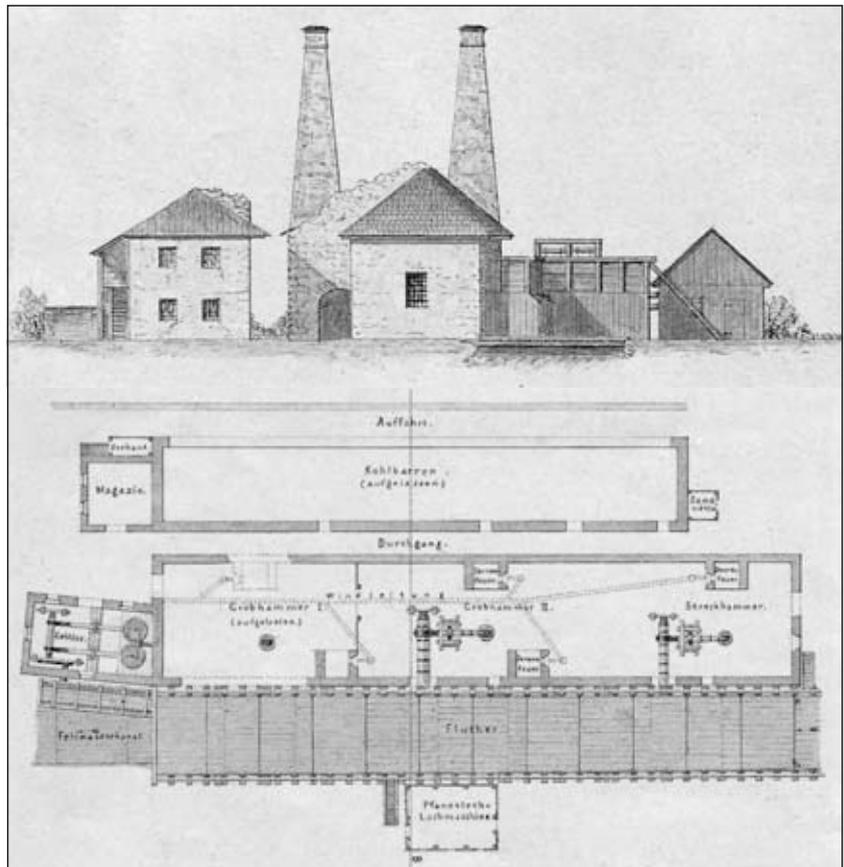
Hammerwerk in Grubegg. Oben: Vorderansicht; unten Grundriss (oben Kohlbarren, Mitte Werksgebäude, unten Fluter). Aus Stadler, Das Hammerwerk ... Anm. (75).
